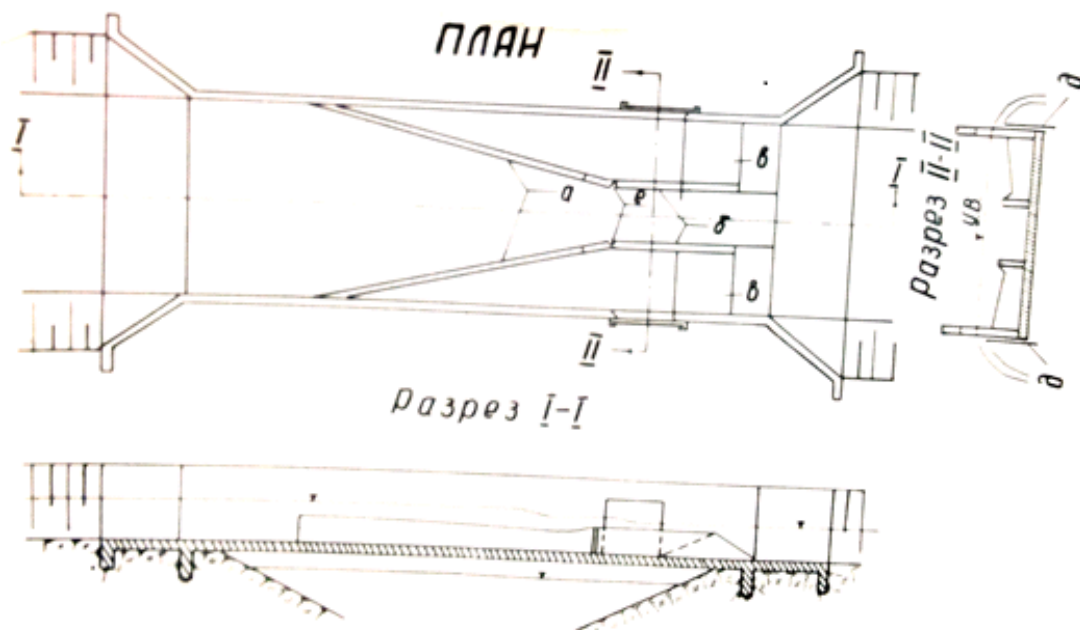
Схема водозабора, совмещенного с водоперепускным сооружением:
